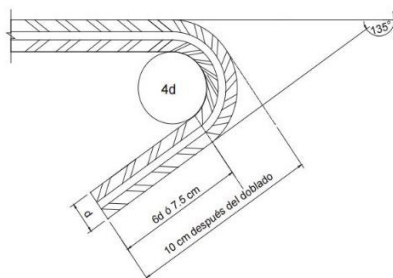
Geometría del gancho Longitud de doblado en estribos de 8mm
